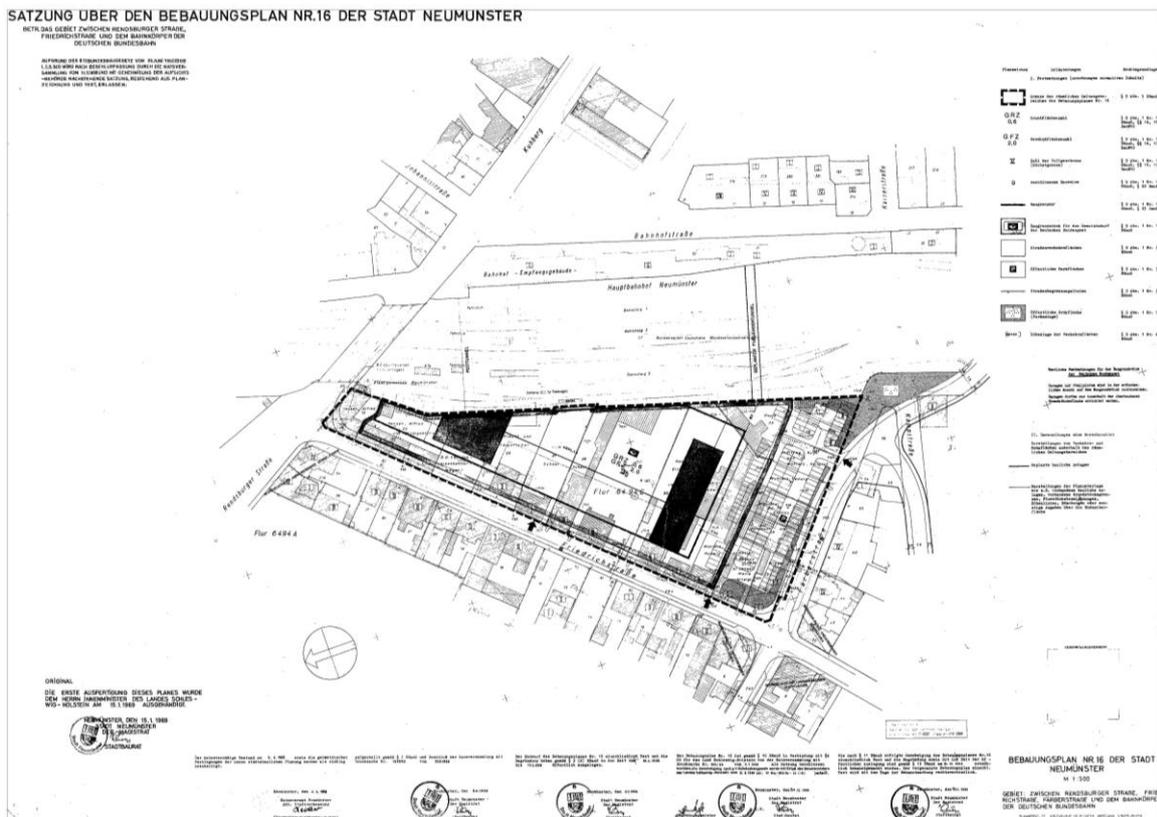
Bebauungsplan Nr.16 „Gebiet zwischen Rendsburger Straße, Friedrichstraße und dem Bahnkörper der Deutschen Bundesbahn“
